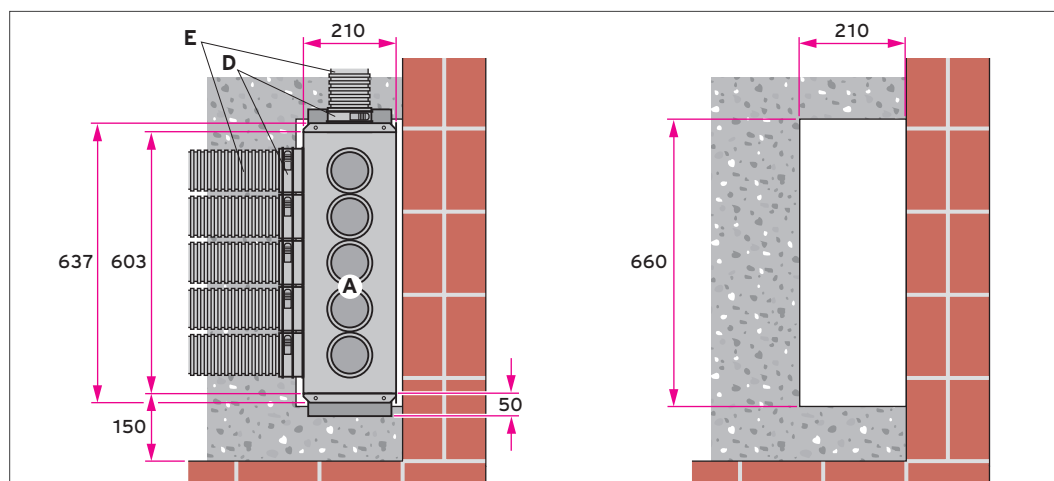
Luftverteiler/-sammler für runde Luftschläuche in der Rohbetondecke, Draufsicht
